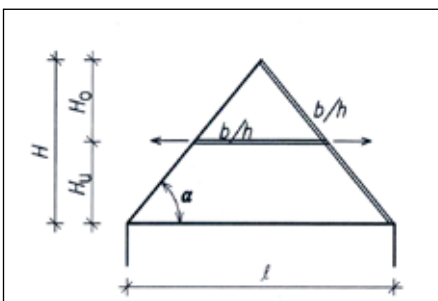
Schéma hambalkové soustavy bez půdní vestavby pro návrh hambalku, zdroj [2]
